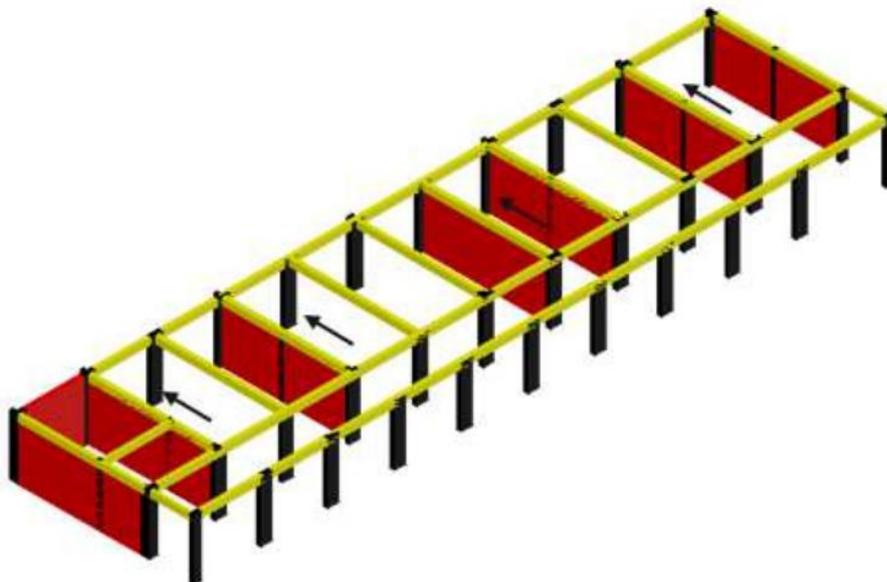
Estructura de pórticos y muros de cargas. Fuente: Moreno (2014).
